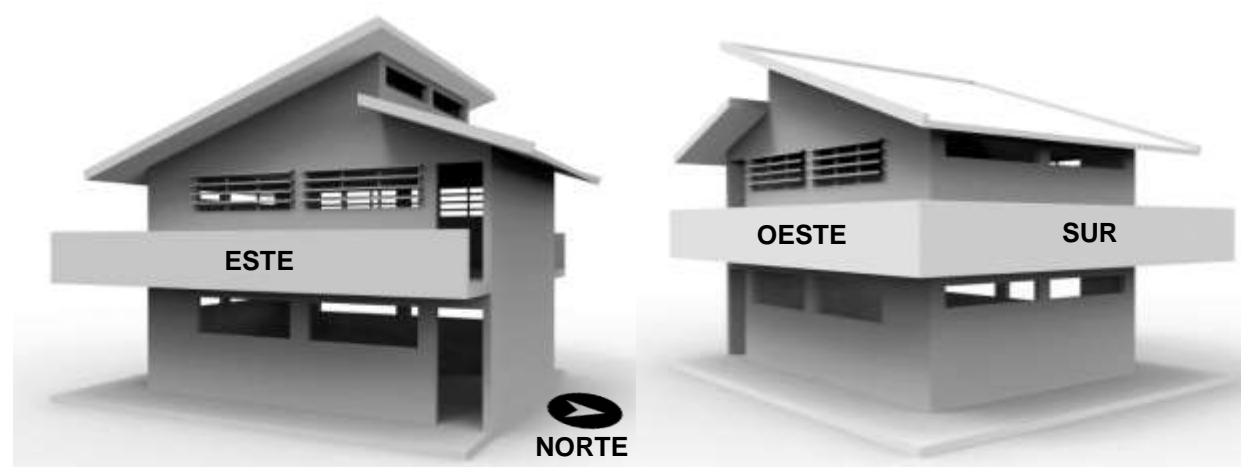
Edificio B, Fachadas noreste y suroeste. Fuente: Elaboración propia.
